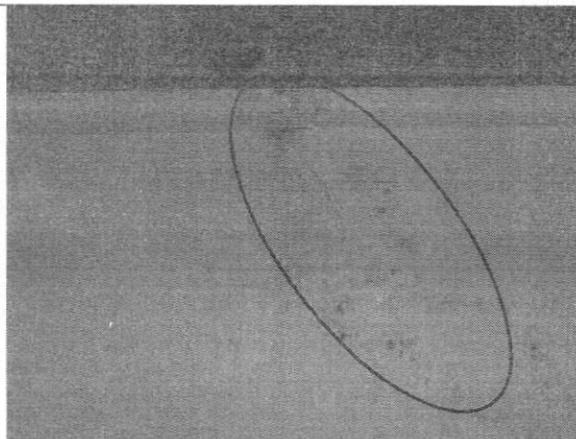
Fisura en muro costado oriental, cara interior.
